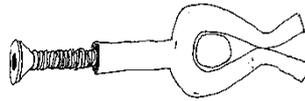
Presilha/ mola de fixação dos painéis à estrutura de madeira.
